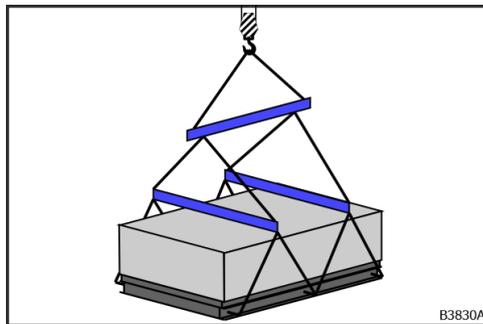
exemple de dispositifs de levage fournis sur site pour 3 barres de levage
